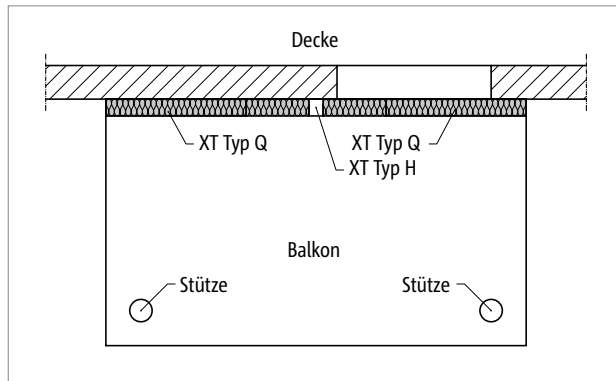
Schöck Isokorb® XT Typ H: Balkon mit Stützenlagerung
